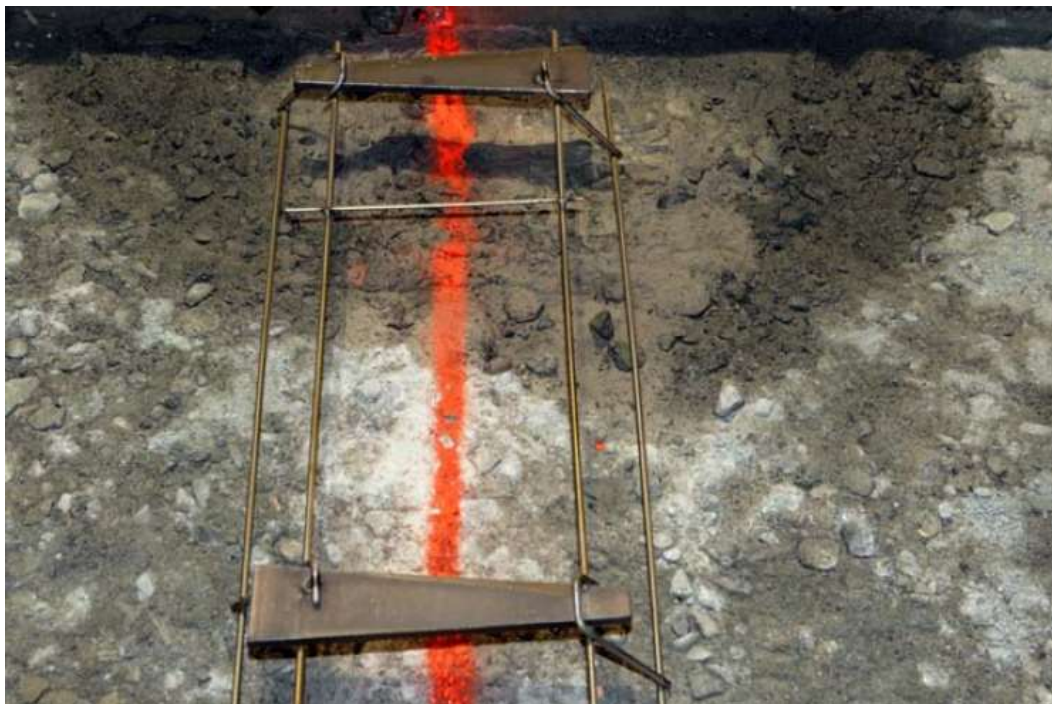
Instalación de un inserto prefabricado para pasador placa diamante sobre un encofrado de madera, en una junta de construcción.
